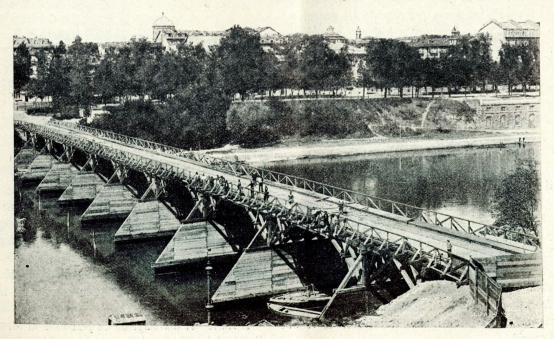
Veduta prospettica dal vero, durante i lavori.
